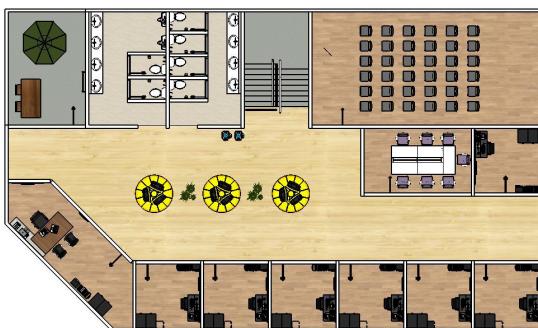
Zoning dan layout lantai 1 h's co-working space
